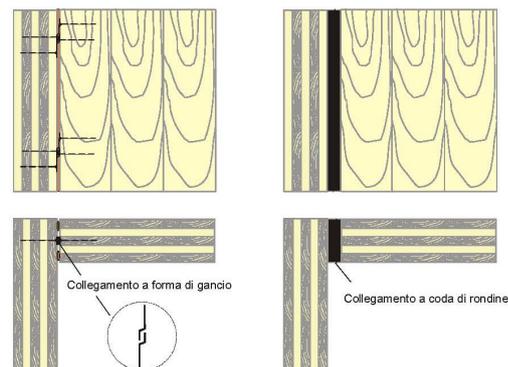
Giunzione parete-parete, possibilità di realizzazione del collegamento d'angolo mediante bullonatura
